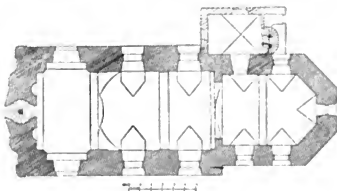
Neu-Knin. Grundriss der Kirche.
